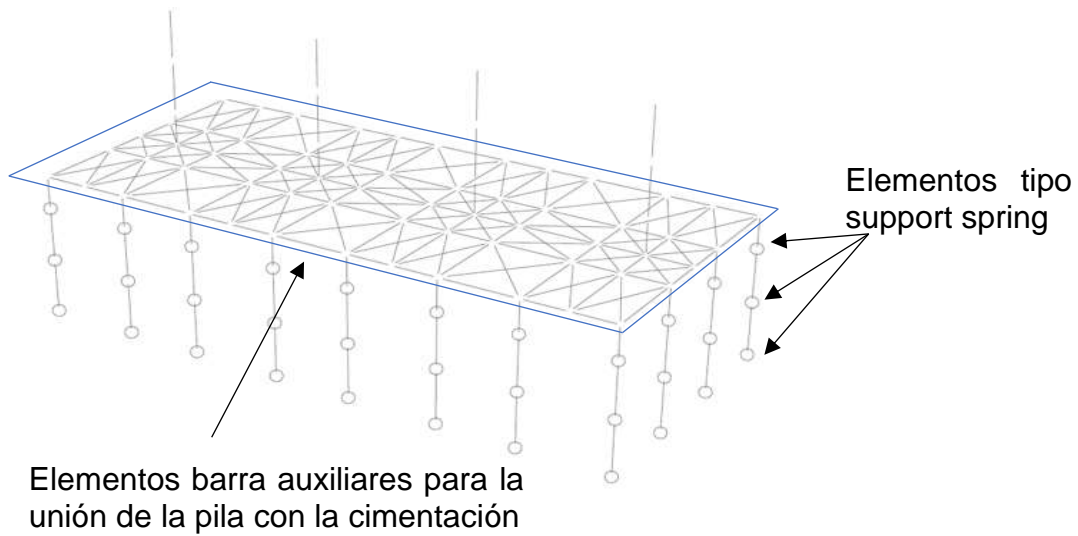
Esquema de la unión de la pila con la cimentación.
